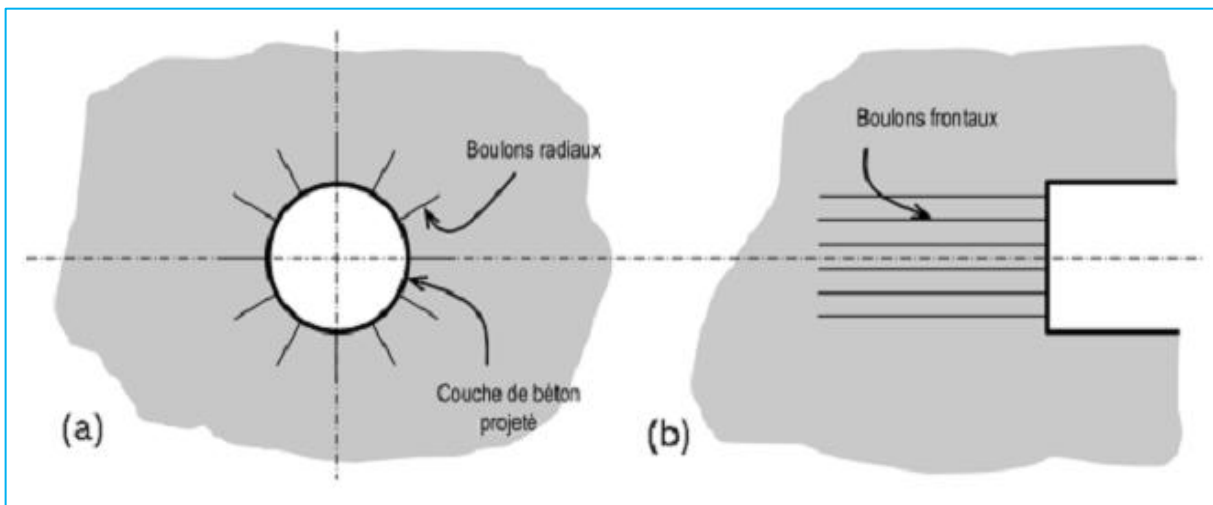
(a) Application de la New Austrian Tunneling Method (b) Boulonnage du front.
